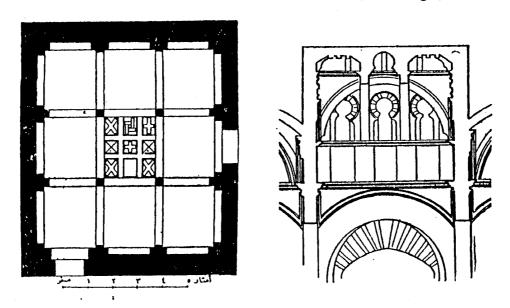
مسقط أفقي لمسجد فنيانه بالأندلس . (عن كمال عناني اسماعيل) .
